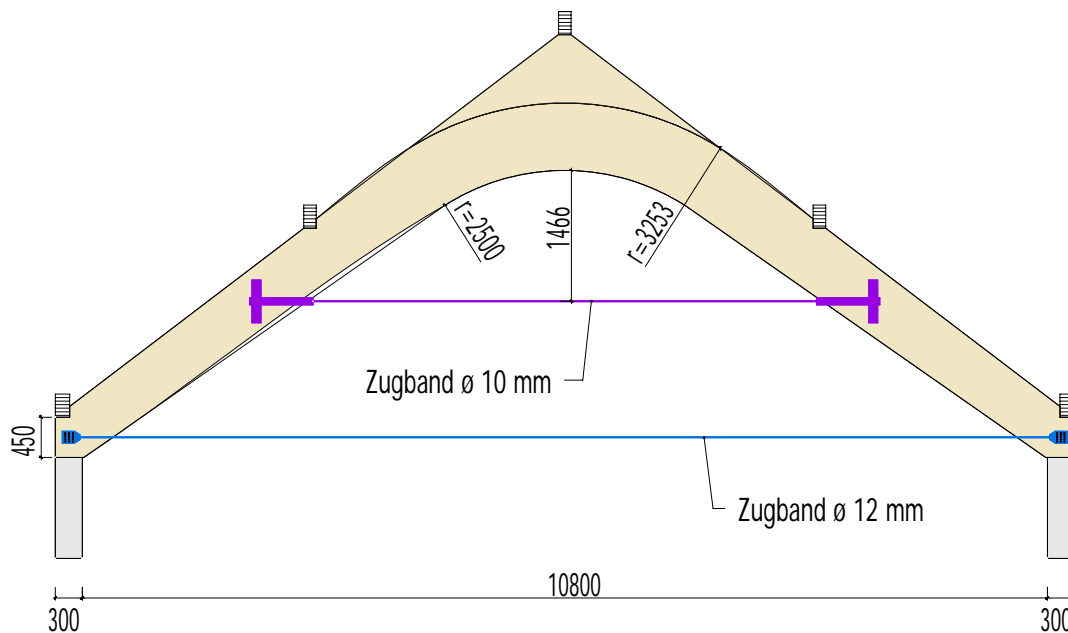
Sanierungsmassnahmen des Bogenbinders:
